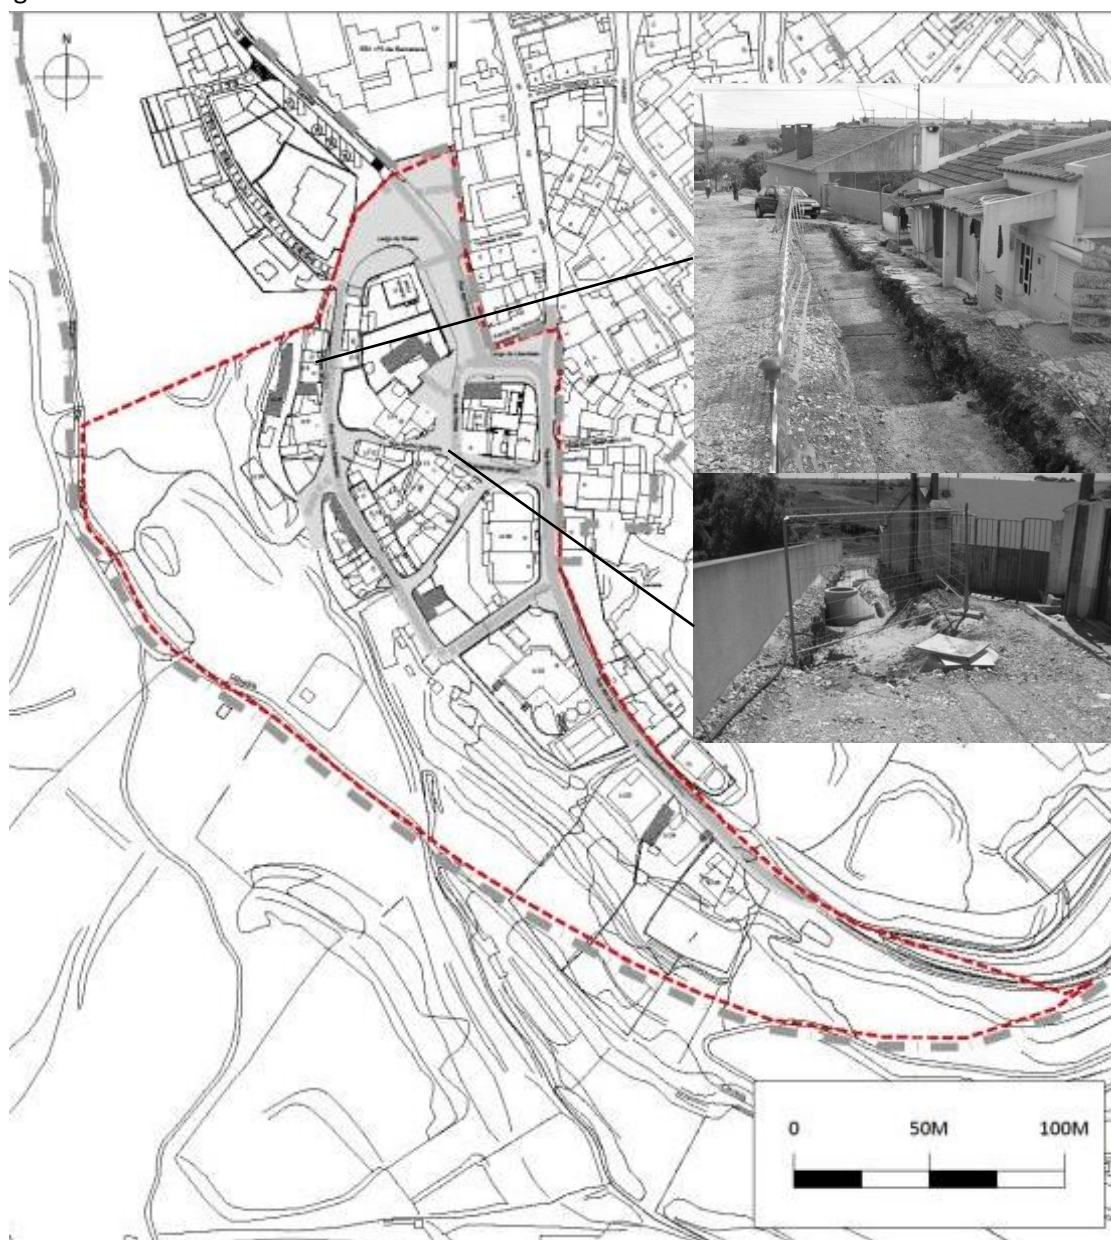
Planta da fase 2 e fotografias da obra de infraestruturas. Fonte: CMO/DPE
